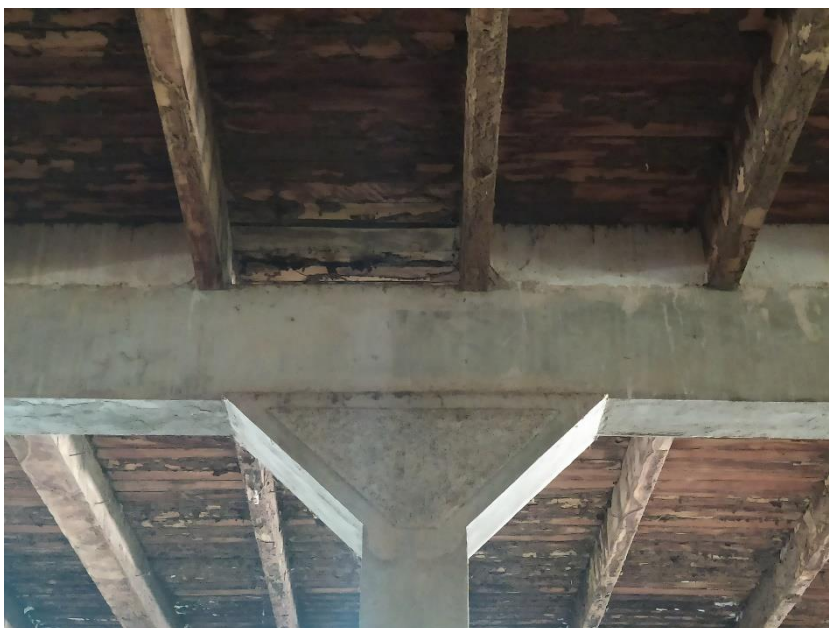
Vista pilar e viga de concreto armado existente que sustentam a estrutura do assoalho
